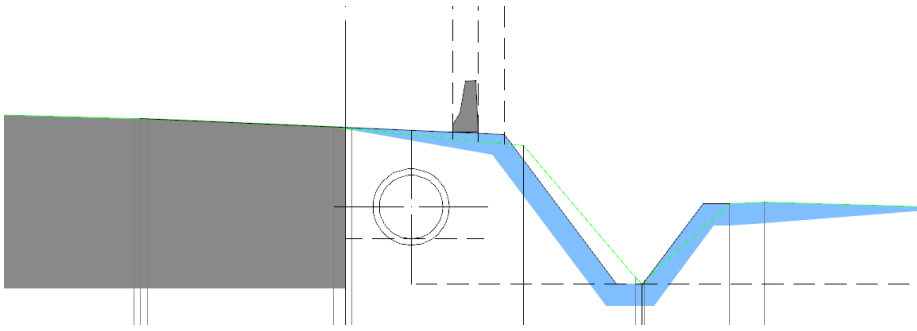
COUPE TYPE D'UN COLLECTEUR SOUS BAU
